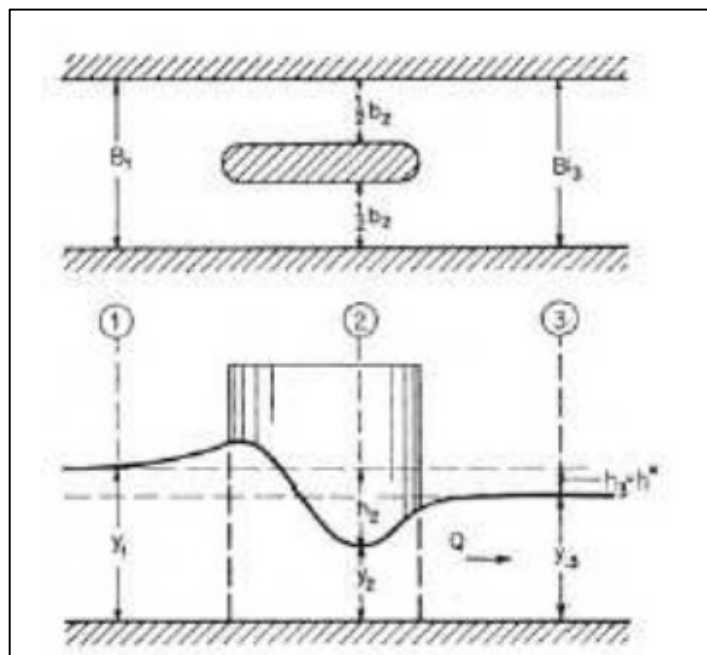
Schema di ostruzione della sezione di deflusso prodotta dalla pila di un ponte (Fonte: Fugazza, 2011).
